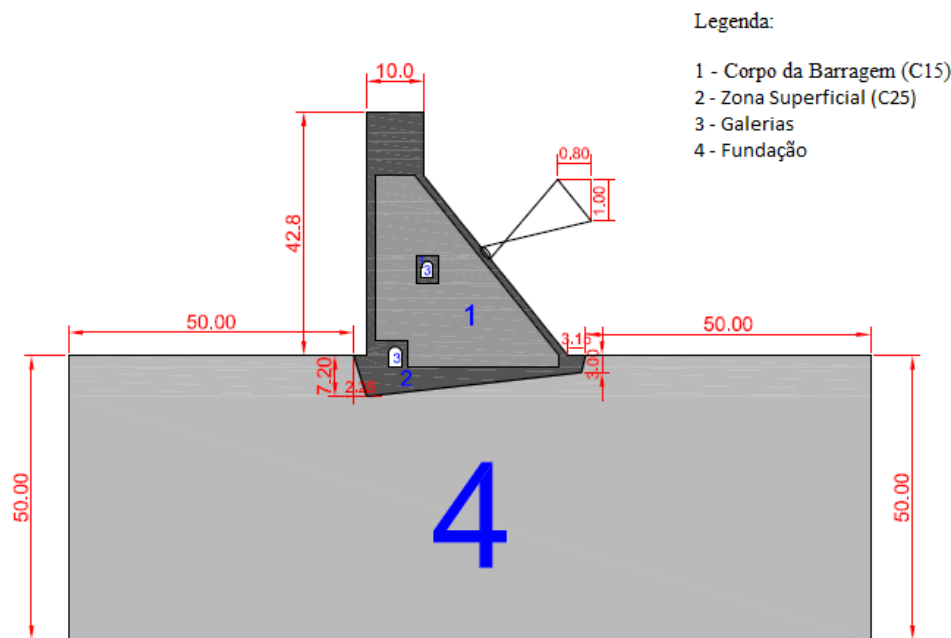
Secção transversal com a geometria do bloco analisado.
